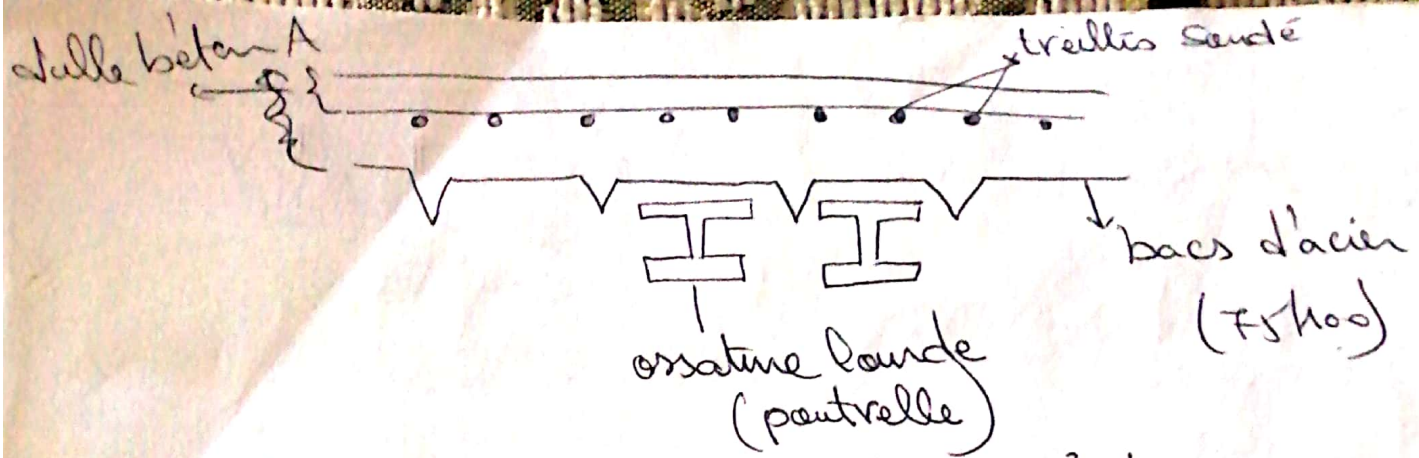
Présentation des composantes d'une dalle mixte (acier -béton).
